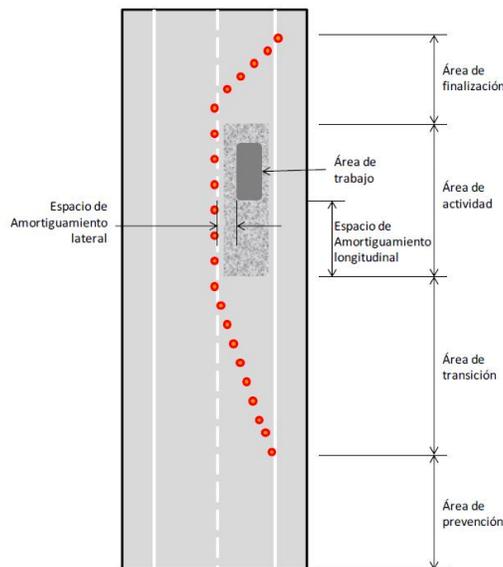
Esquema típico para canalización de zonas intervenidas por instalación de tubería en casco urbano.
